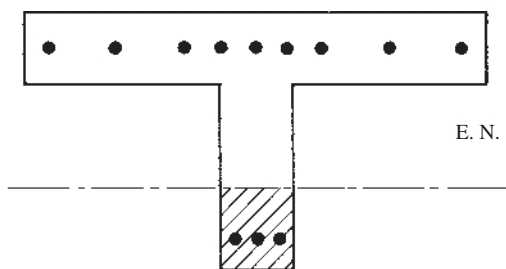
Viga T con patín en tensión y parte inferior (achurada) en compresión (una viga rectangular).
